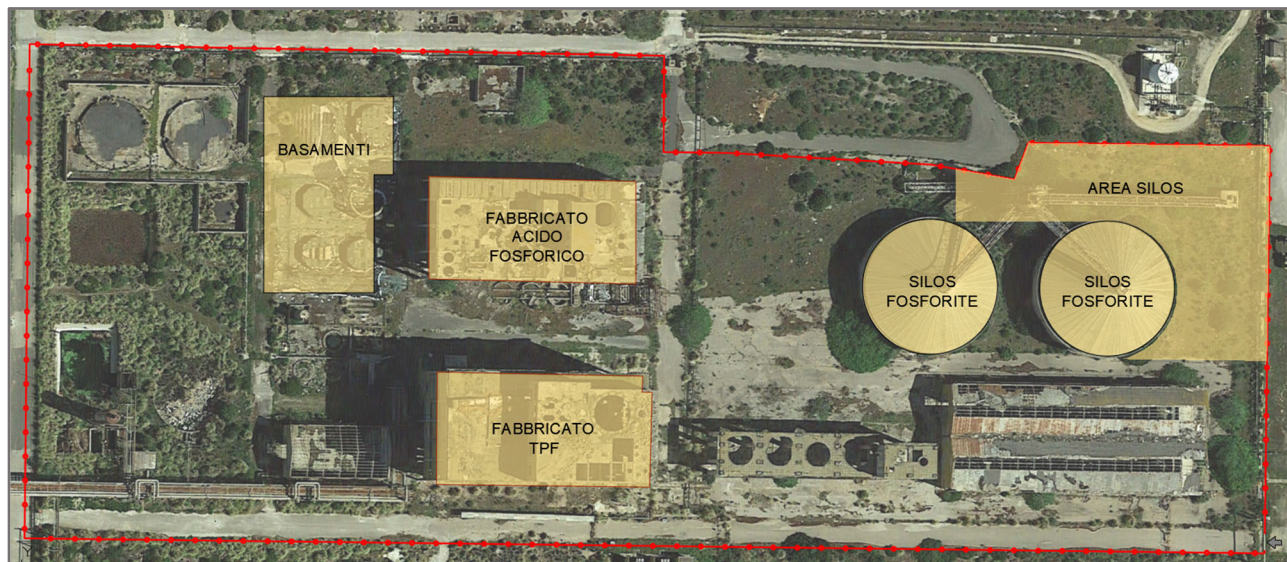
Ortofoto dell'Area ex Impianto TPF con individuazione delle zone di intervento
